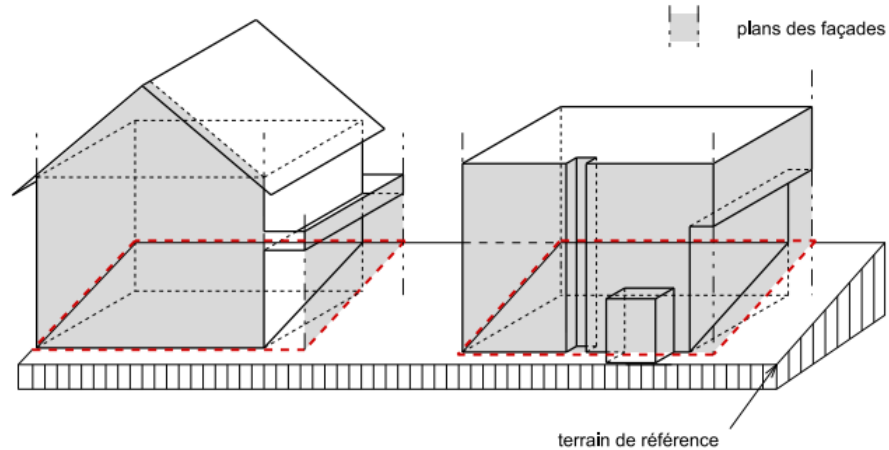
3.3 Plans des façades et projection du pied de façade
